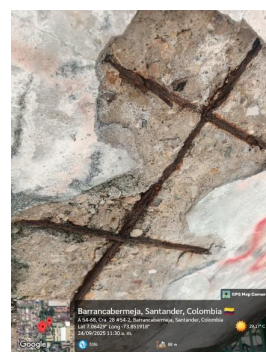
Apoyo del descanso de la escalera de acceso al puente.
